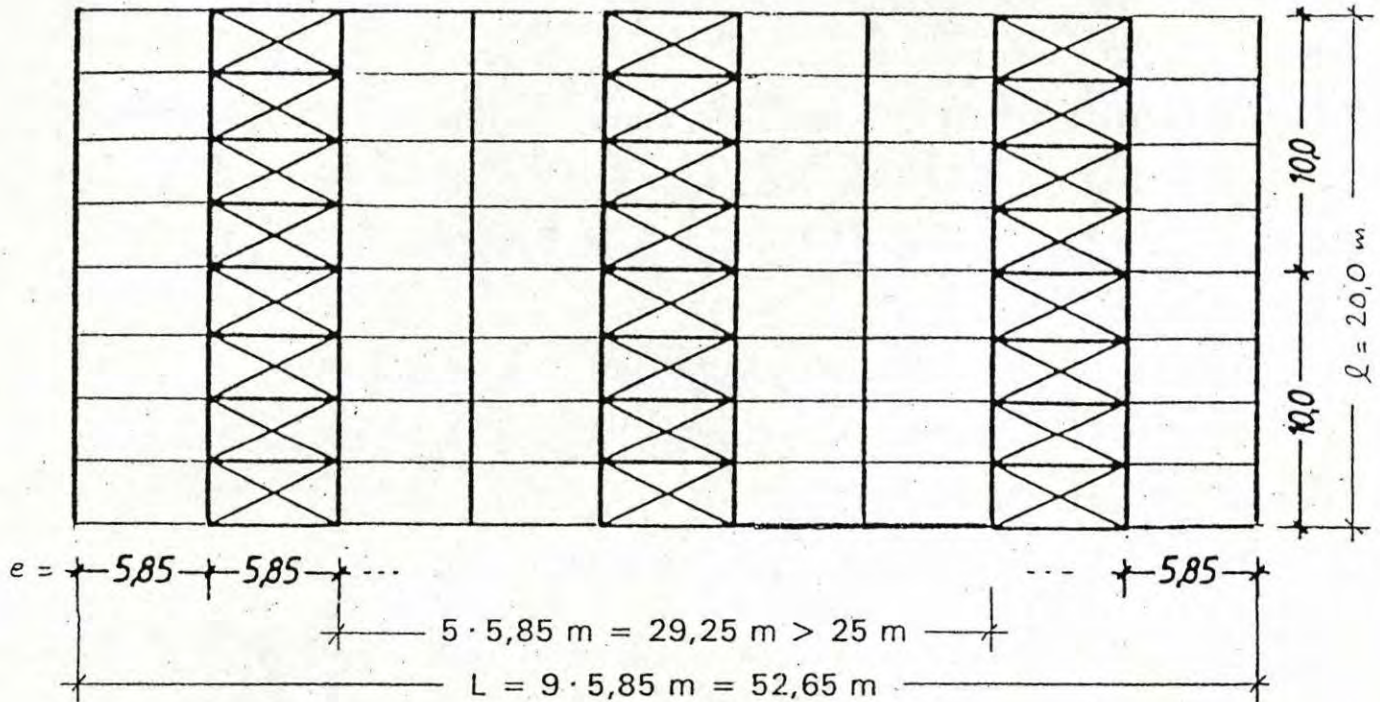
Grundriß einer neun Felder langen Halle mit den in Beispiel 9.2 berechneten Wind- und Aussteifungsverbänden im Dach (nach [62])
